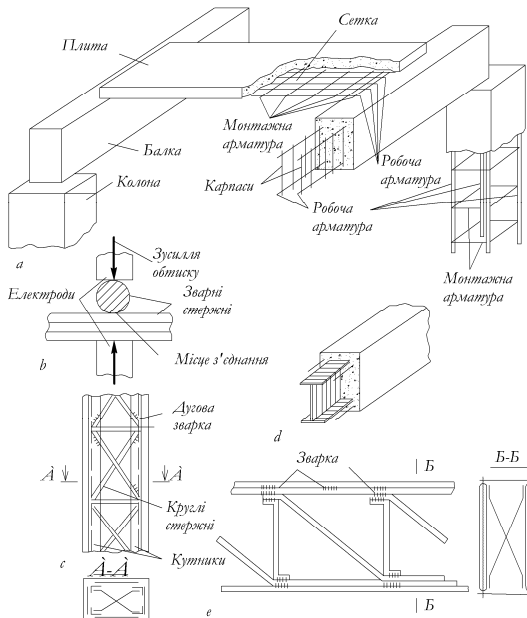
Методи армування залізобетонних елементів: а–каркасами і сітками (гнучка арматура); б–схема контактної точкової зварки стержнів арматури; с–балка з жорсткою арматурою; д–колонна з несучим арматурним каркасом; е–зварний несучий арматурний каркас балки
